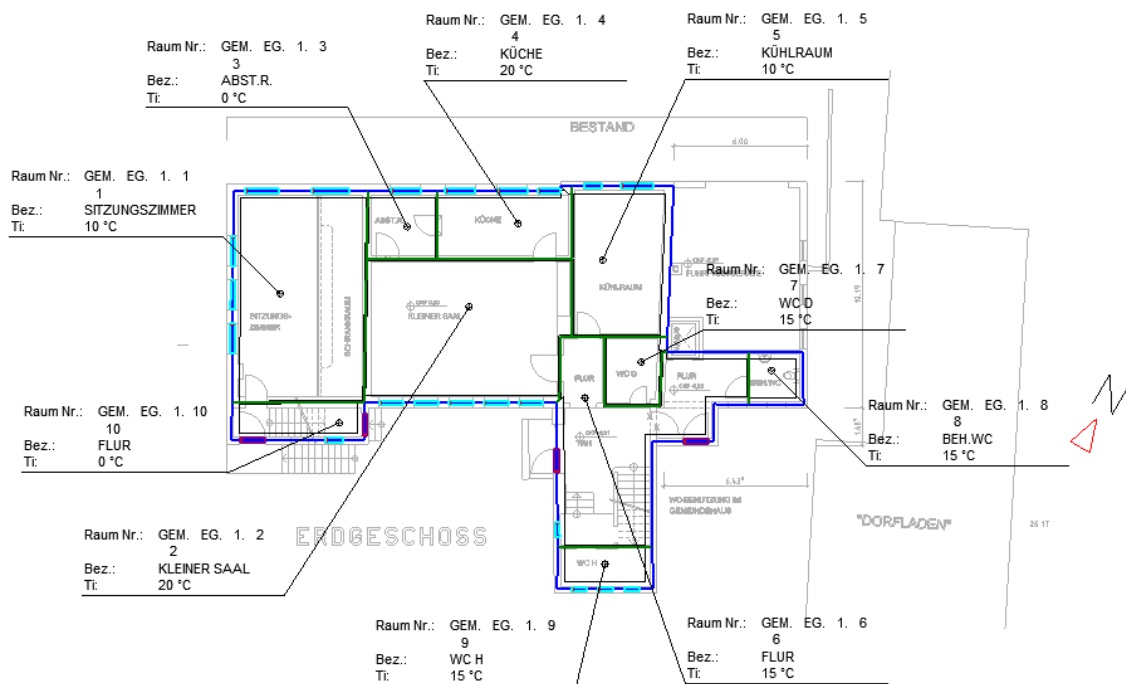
Plan Erdgeschoss Gemeindehaus (erstellt mit mh-Software)
